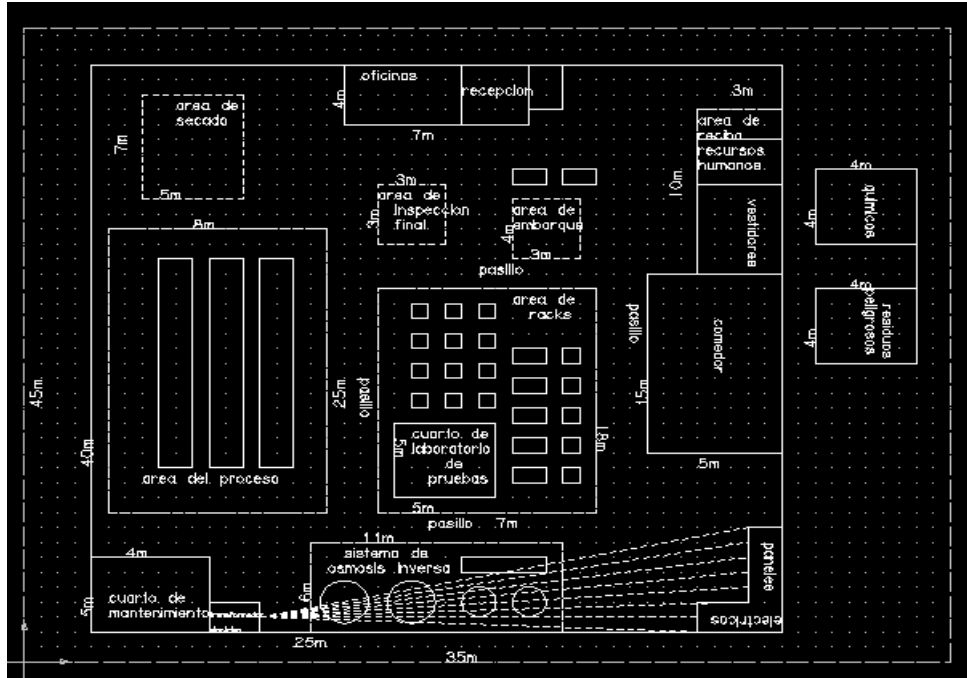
Plano de la planta de anodizado y cálculo de las aéreas.
